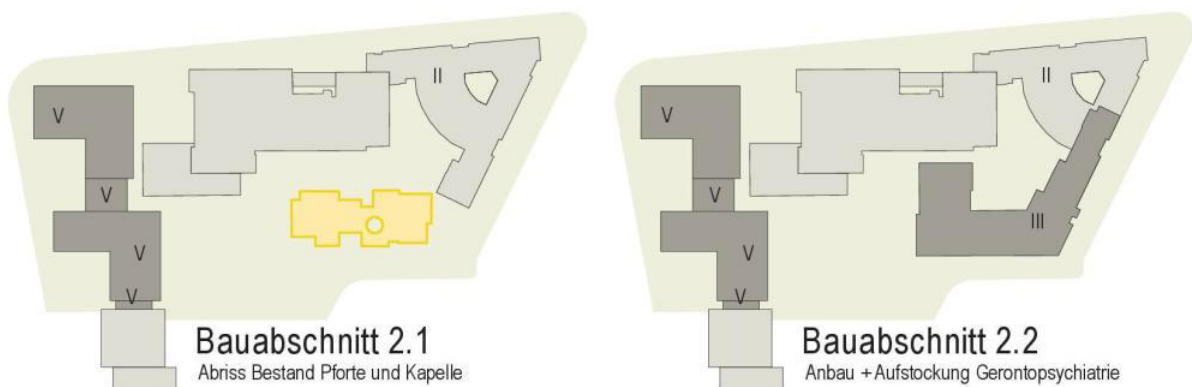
Bauabschnitt 2.1 (Abriss Pforte und Kapelle) /2.2 (Erweiterung Gerontopsychiatrie)
